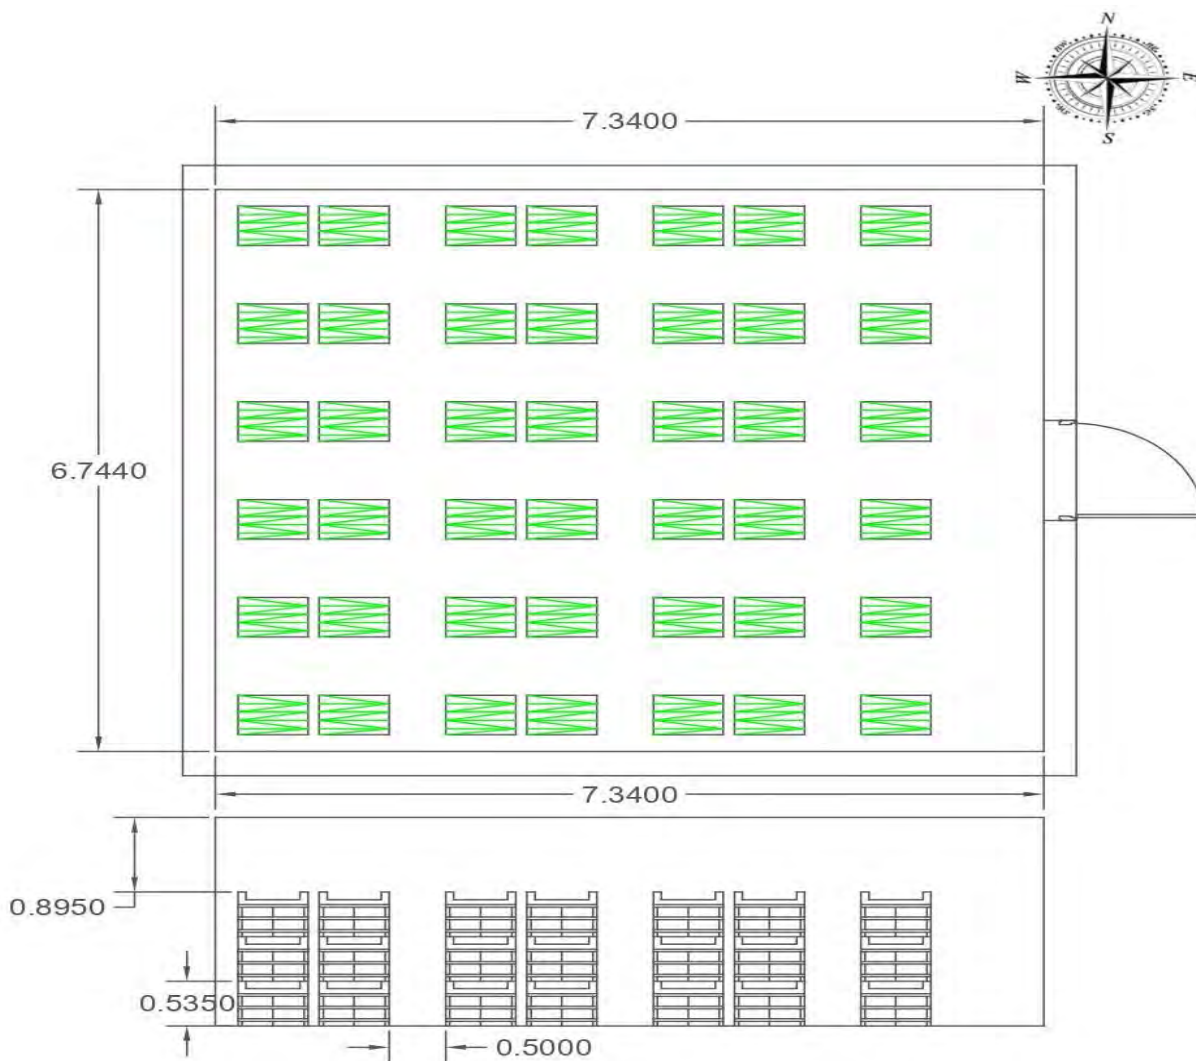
Plano de la cámara frigorífica, vista de planta y lateral.
